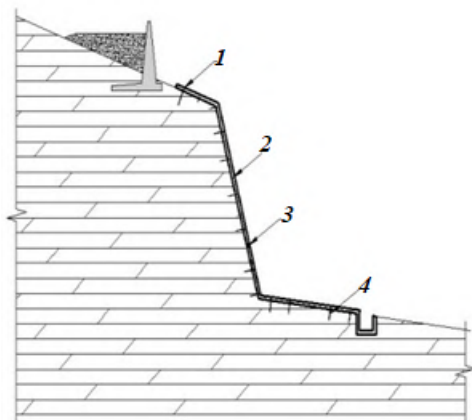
Пример постановки задачи с использованием подпорной стенки для укрепления насыпи: 1 – несущий анкер; слой покрытия по металлической сетке; 3 – отверстие для выпуска воды; 4 – монтажные анкеры
